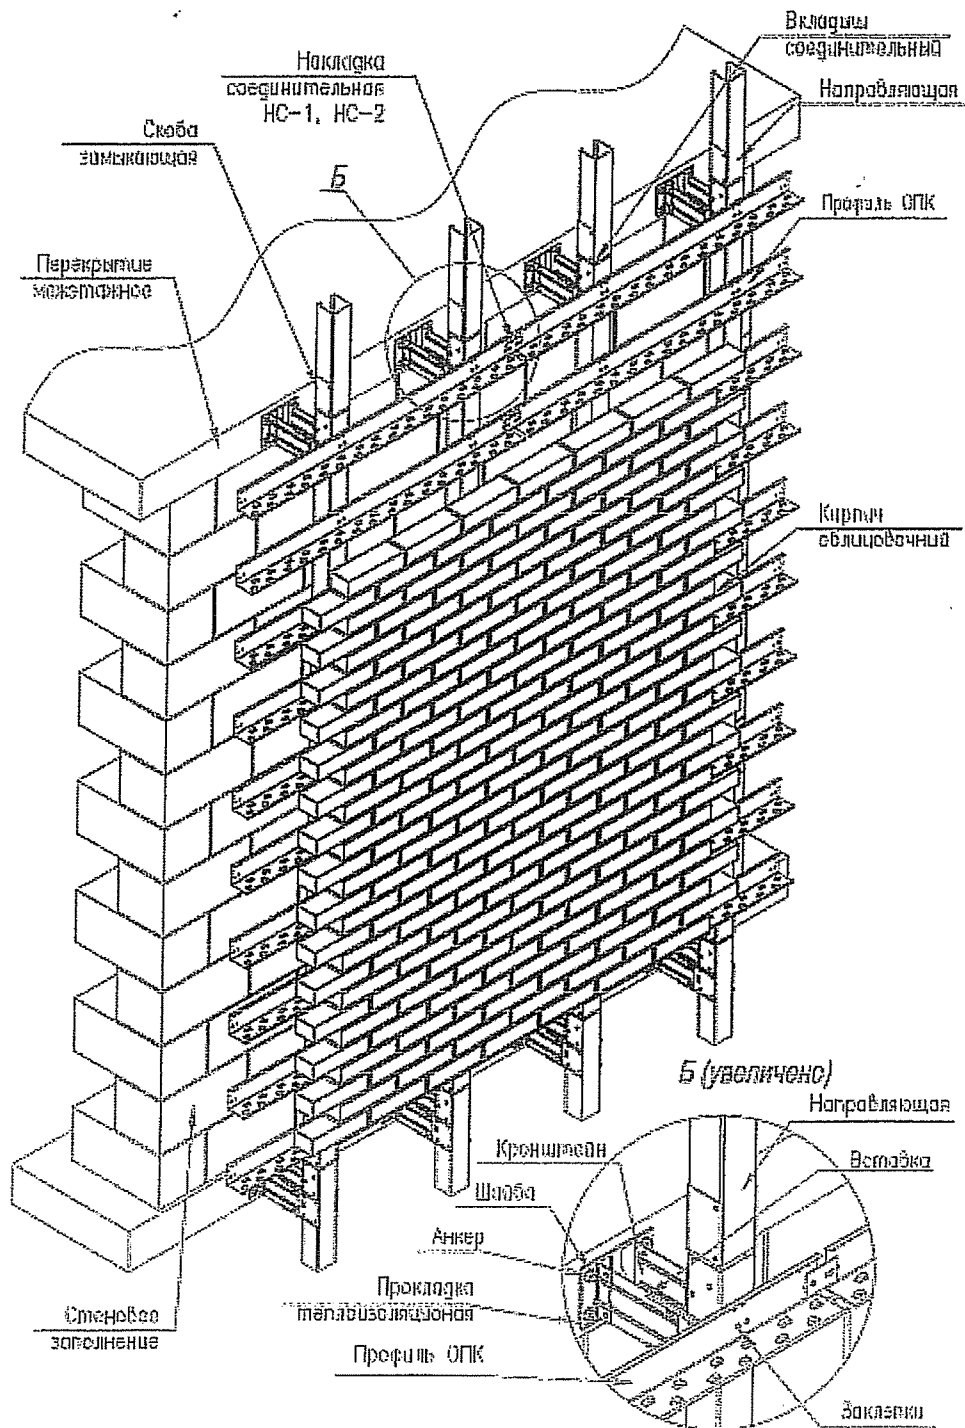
Фрагмент навесной фасадной системы «ОЛМА» для облицовки фасадным кирпичом.
